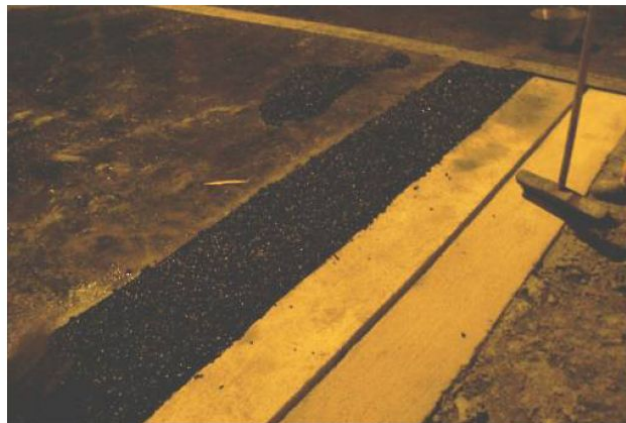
Pavimentação em um lado da junta (um lado do berço).
